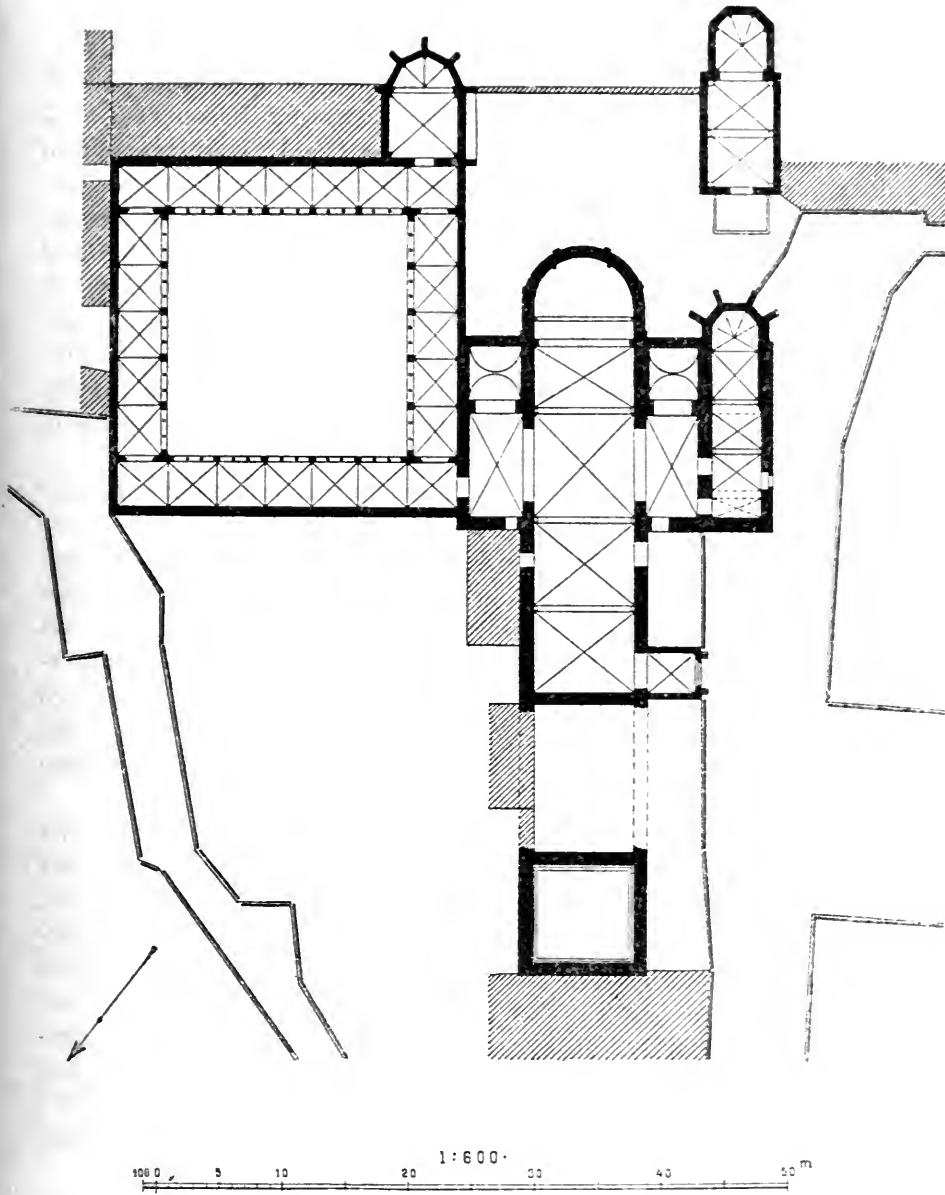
Lageplan der Stiftskirche mit den angrenzenden Gebäuden.
